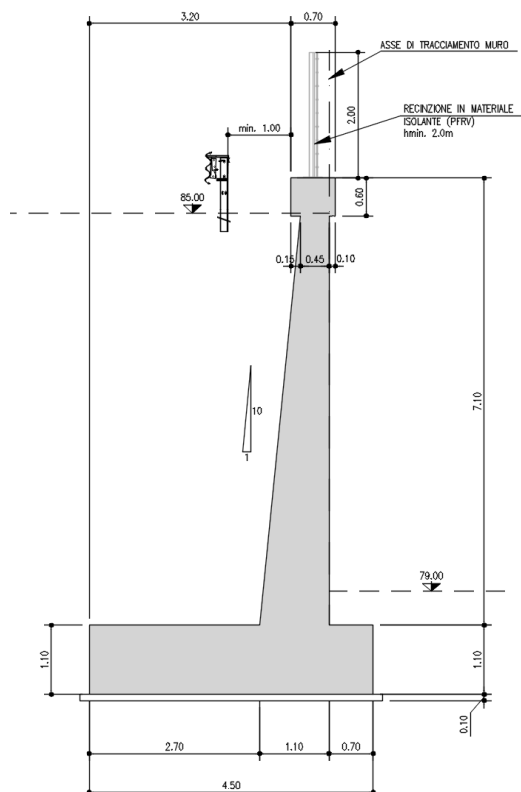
Geometria dell'opera – sezione tipo 1
